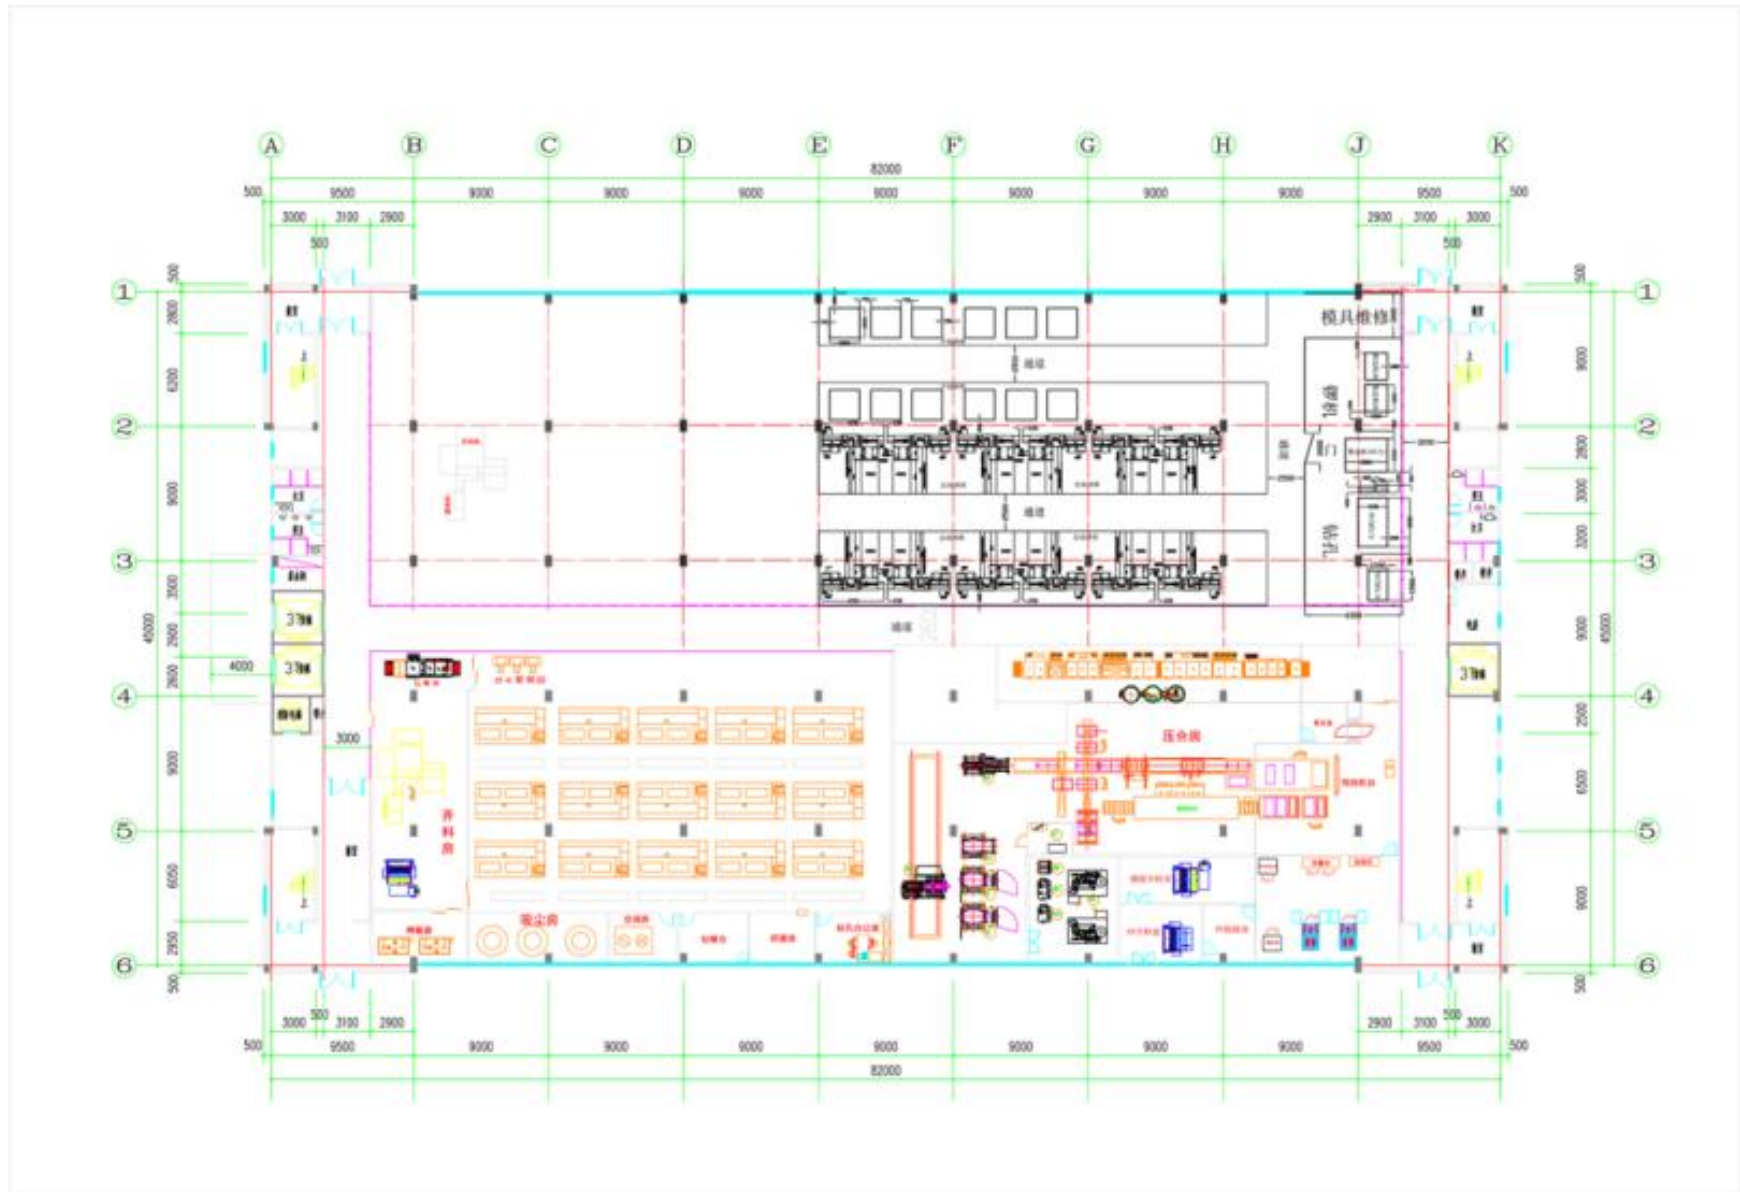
本项目三号厂房 1 楼环评阶段平面布置图
